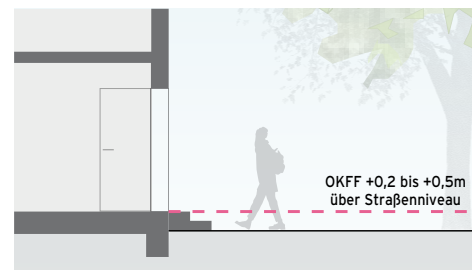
| Höhe Oberkante Fertigfußboden (OKFF) Erdgeschoss
